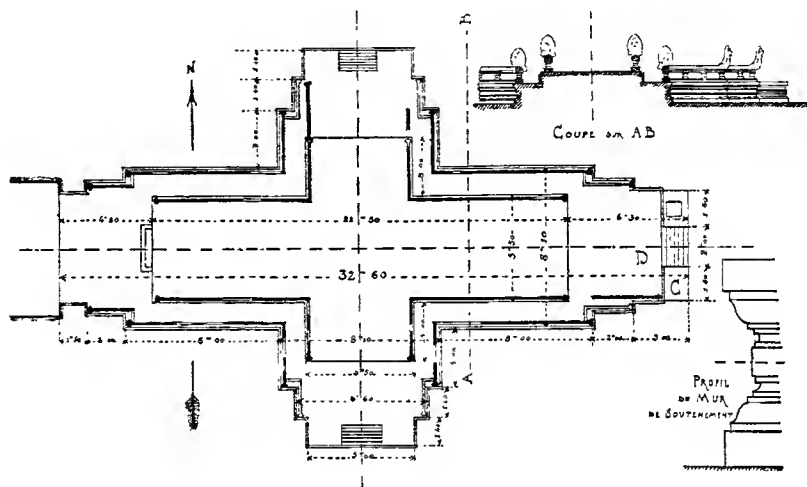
PLAN ET COUPE DE LA TERRASSE ROYALE.
